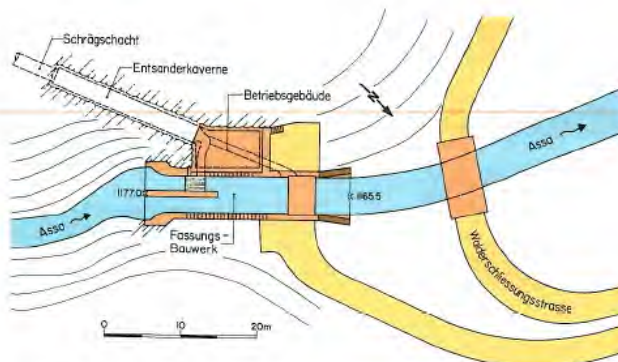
Situationsplan Fassungsbauwerk. Mit dem Tirolerwehr wird das Wasser aus dem Val d'Assa gefasst und durch einen Sandfang zum Schrägschacht geleitet.
